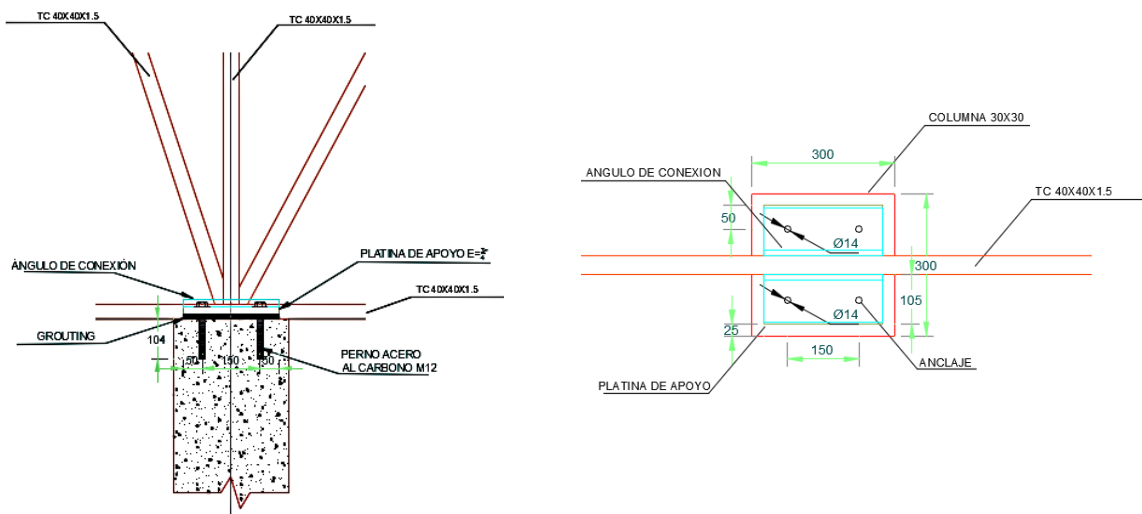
Detalle de la conexión entre la cercha y la columna, Zona A.
